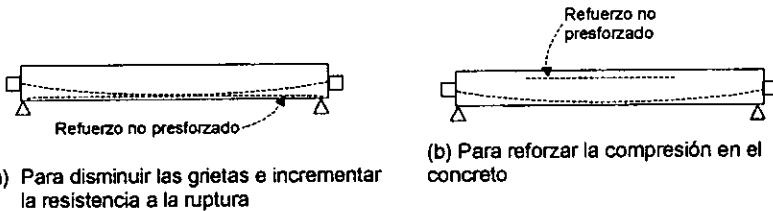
Refuerzo no presforzado para reforzar las vigas bajo las cargas de trabajo y de ruptura
